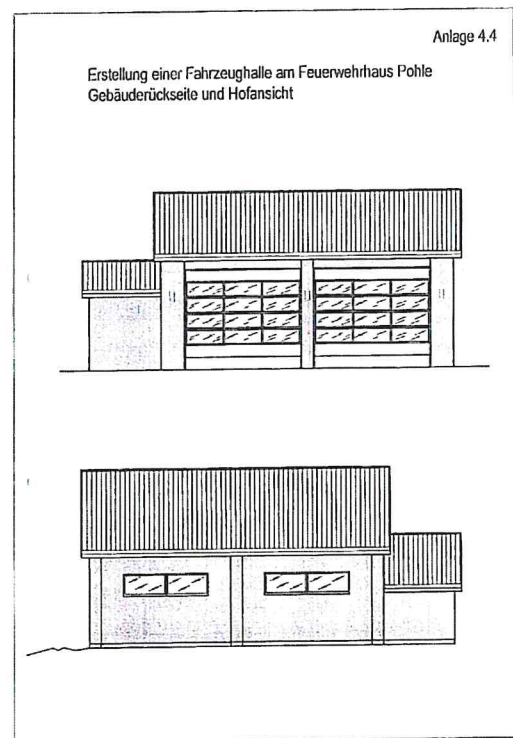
Hofansicht / Gebäuderückseite der Fahrzeughalle
